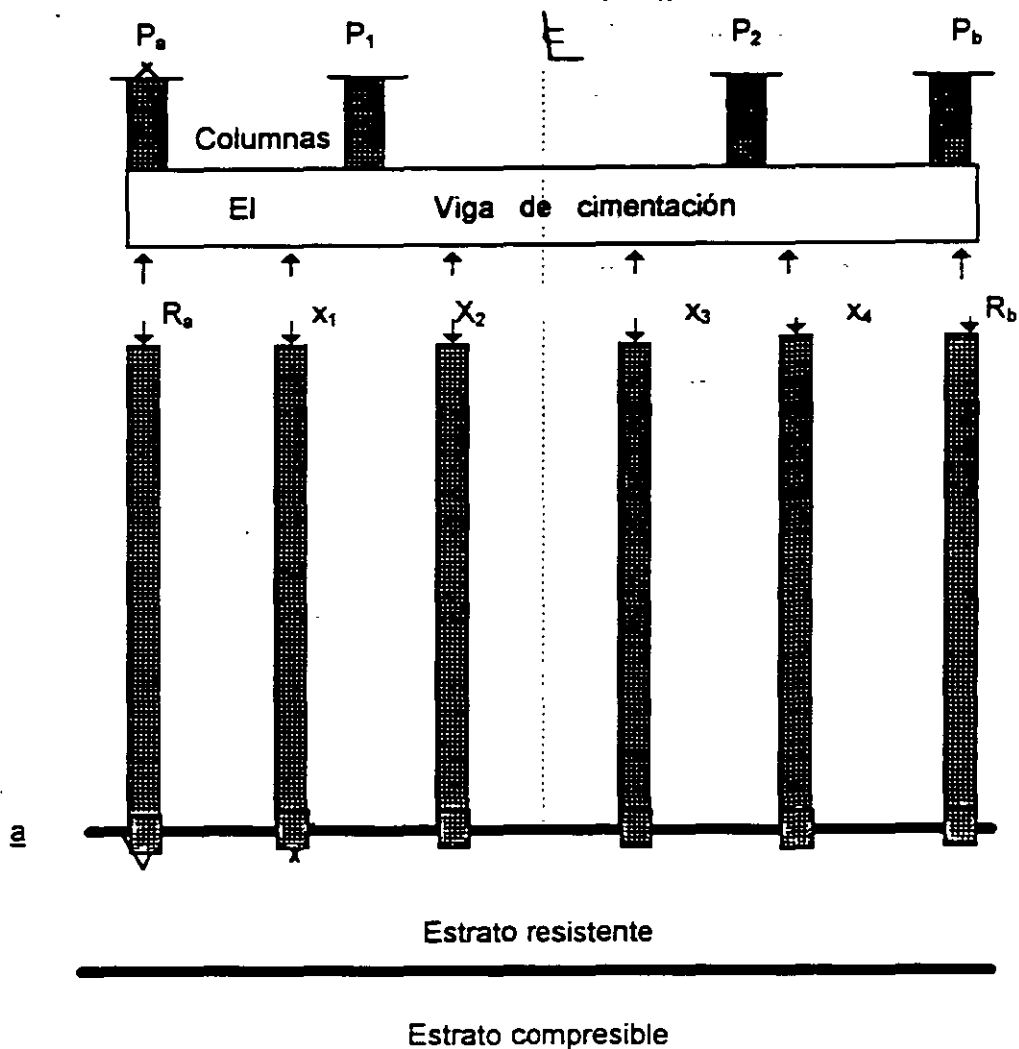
CIMENTACIÓN CON PILOTES. CASO II
